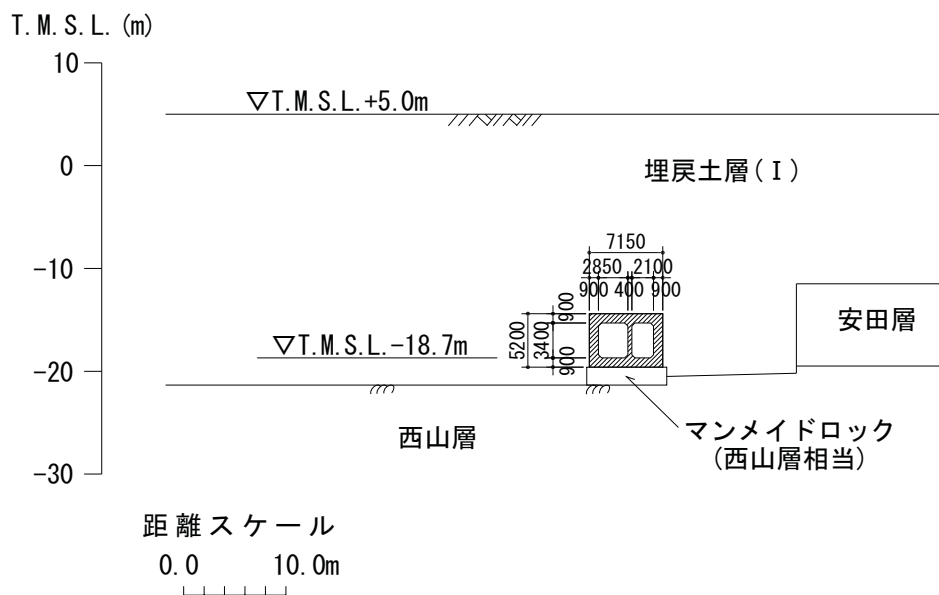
原子炉補機冷却系配管ダクト (A系) 断面図 (D-D断面)
